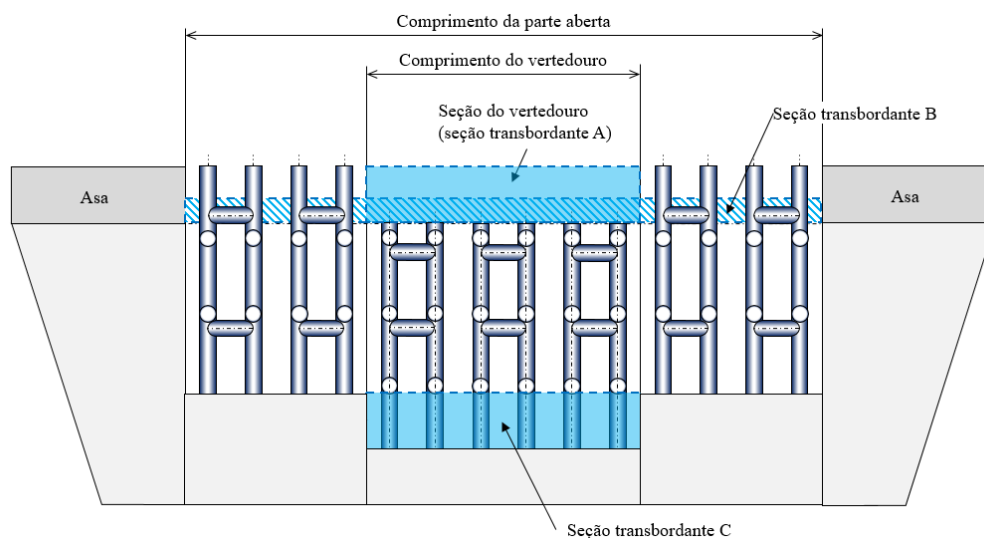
Seção do vertedouro estrutura reticulada também instalada na parte não transbordante (comprimento da parte aberta \neq comprimento do vertedouro)
